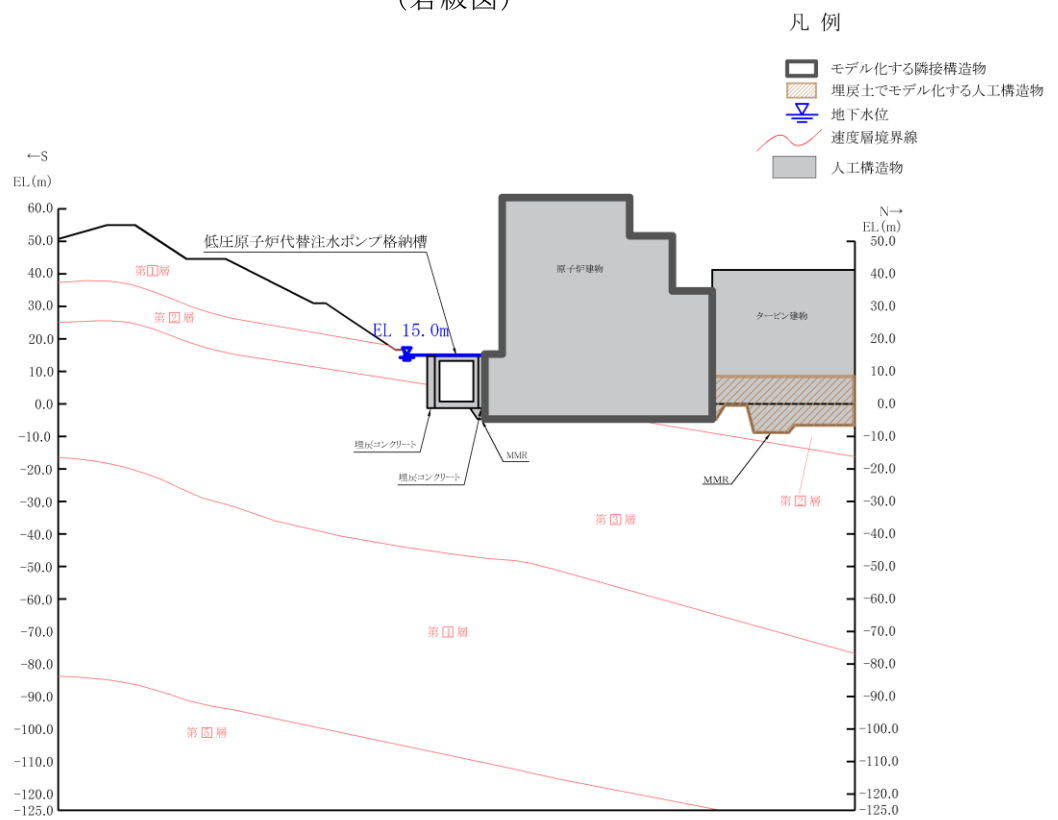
低压原子炉代替注水ポンプ格納槽 評価対象断面図 (A-A断面)
